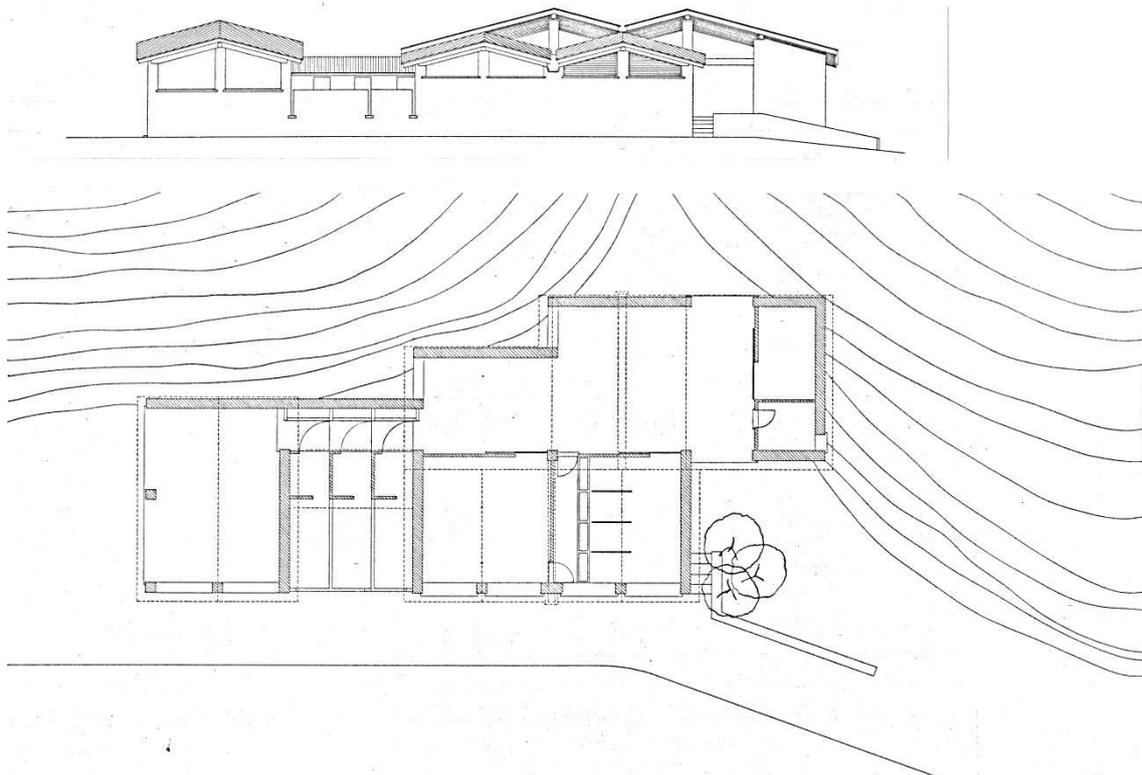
Planta e Alçado da Quinta da Canameira, 1955.
